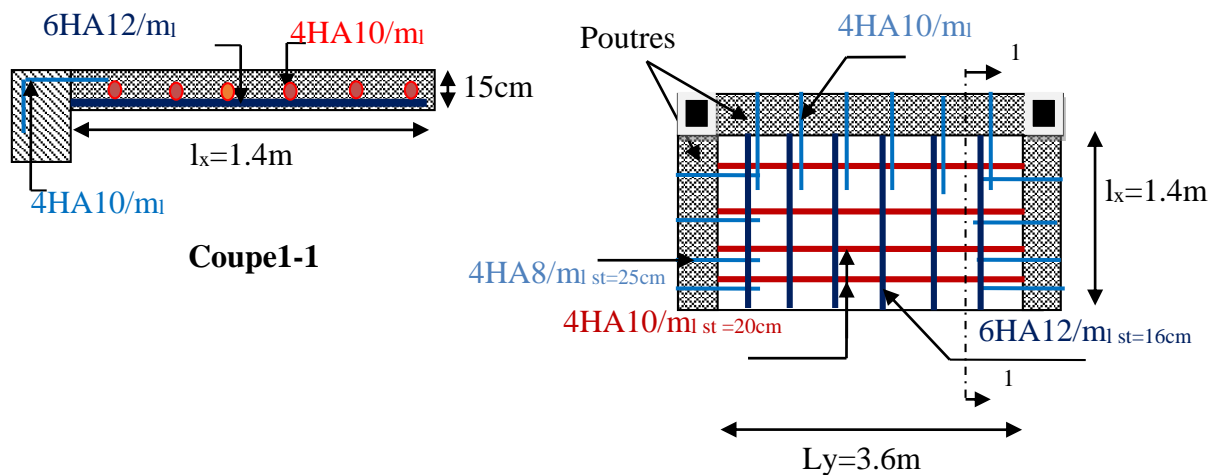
Schéma de ferrailage de dalle balcon.
